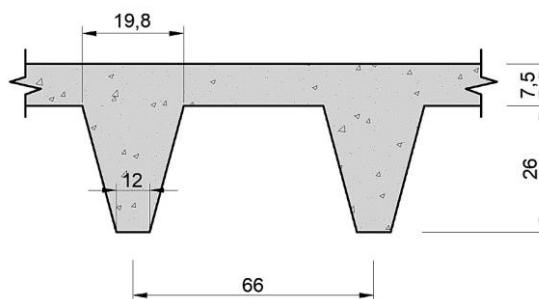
Projeto B2 - Seção de laje nervurada (dimensões em cm).
